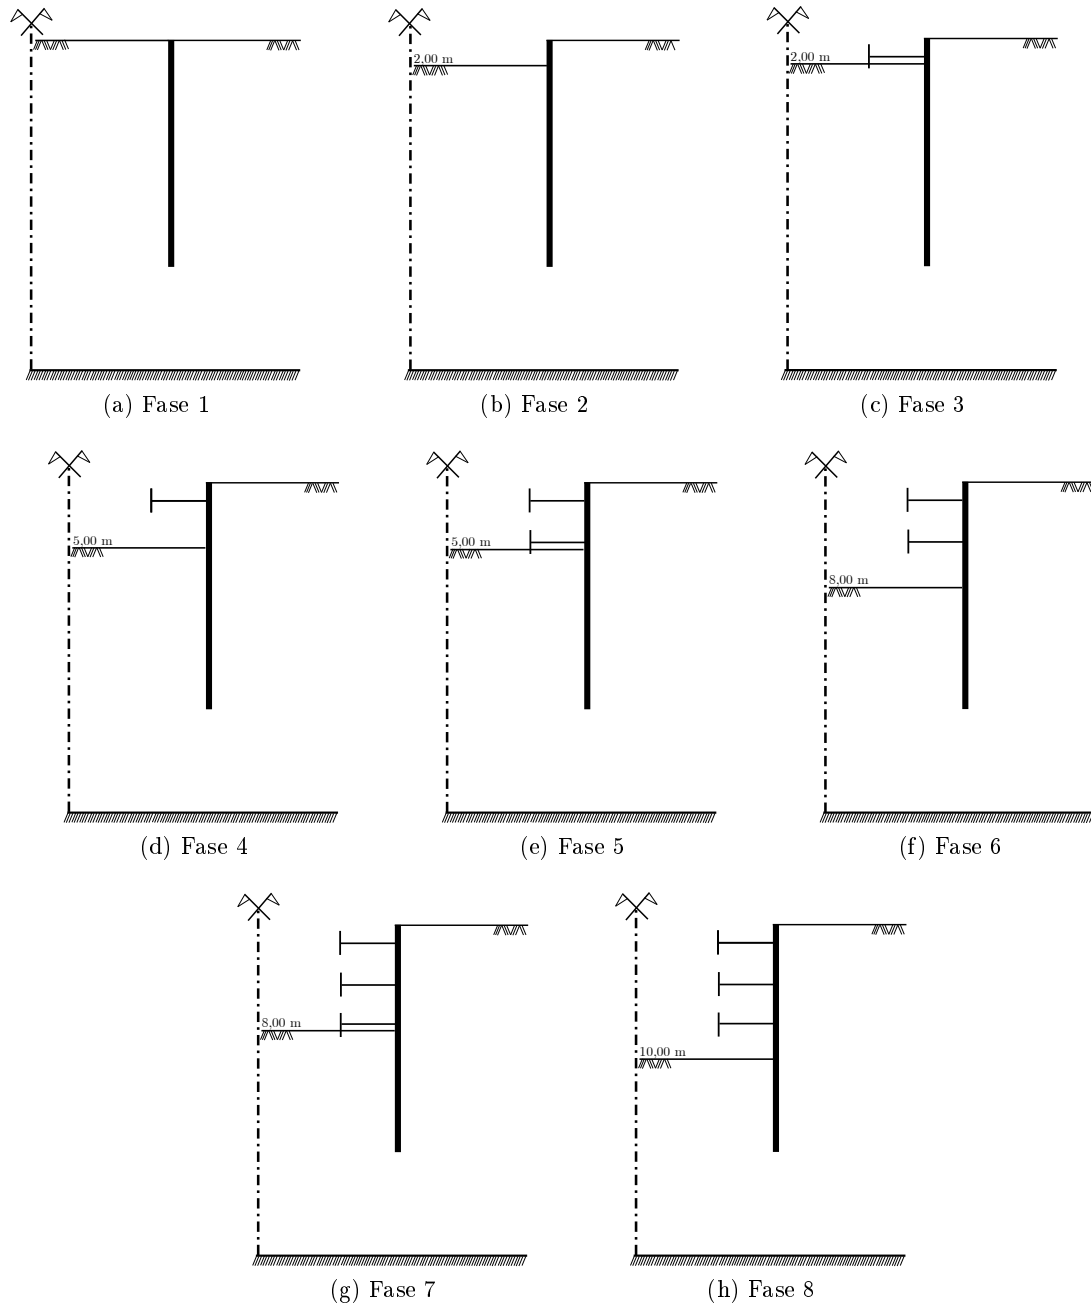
Faseamento construtivo adotado nos cálculos.
